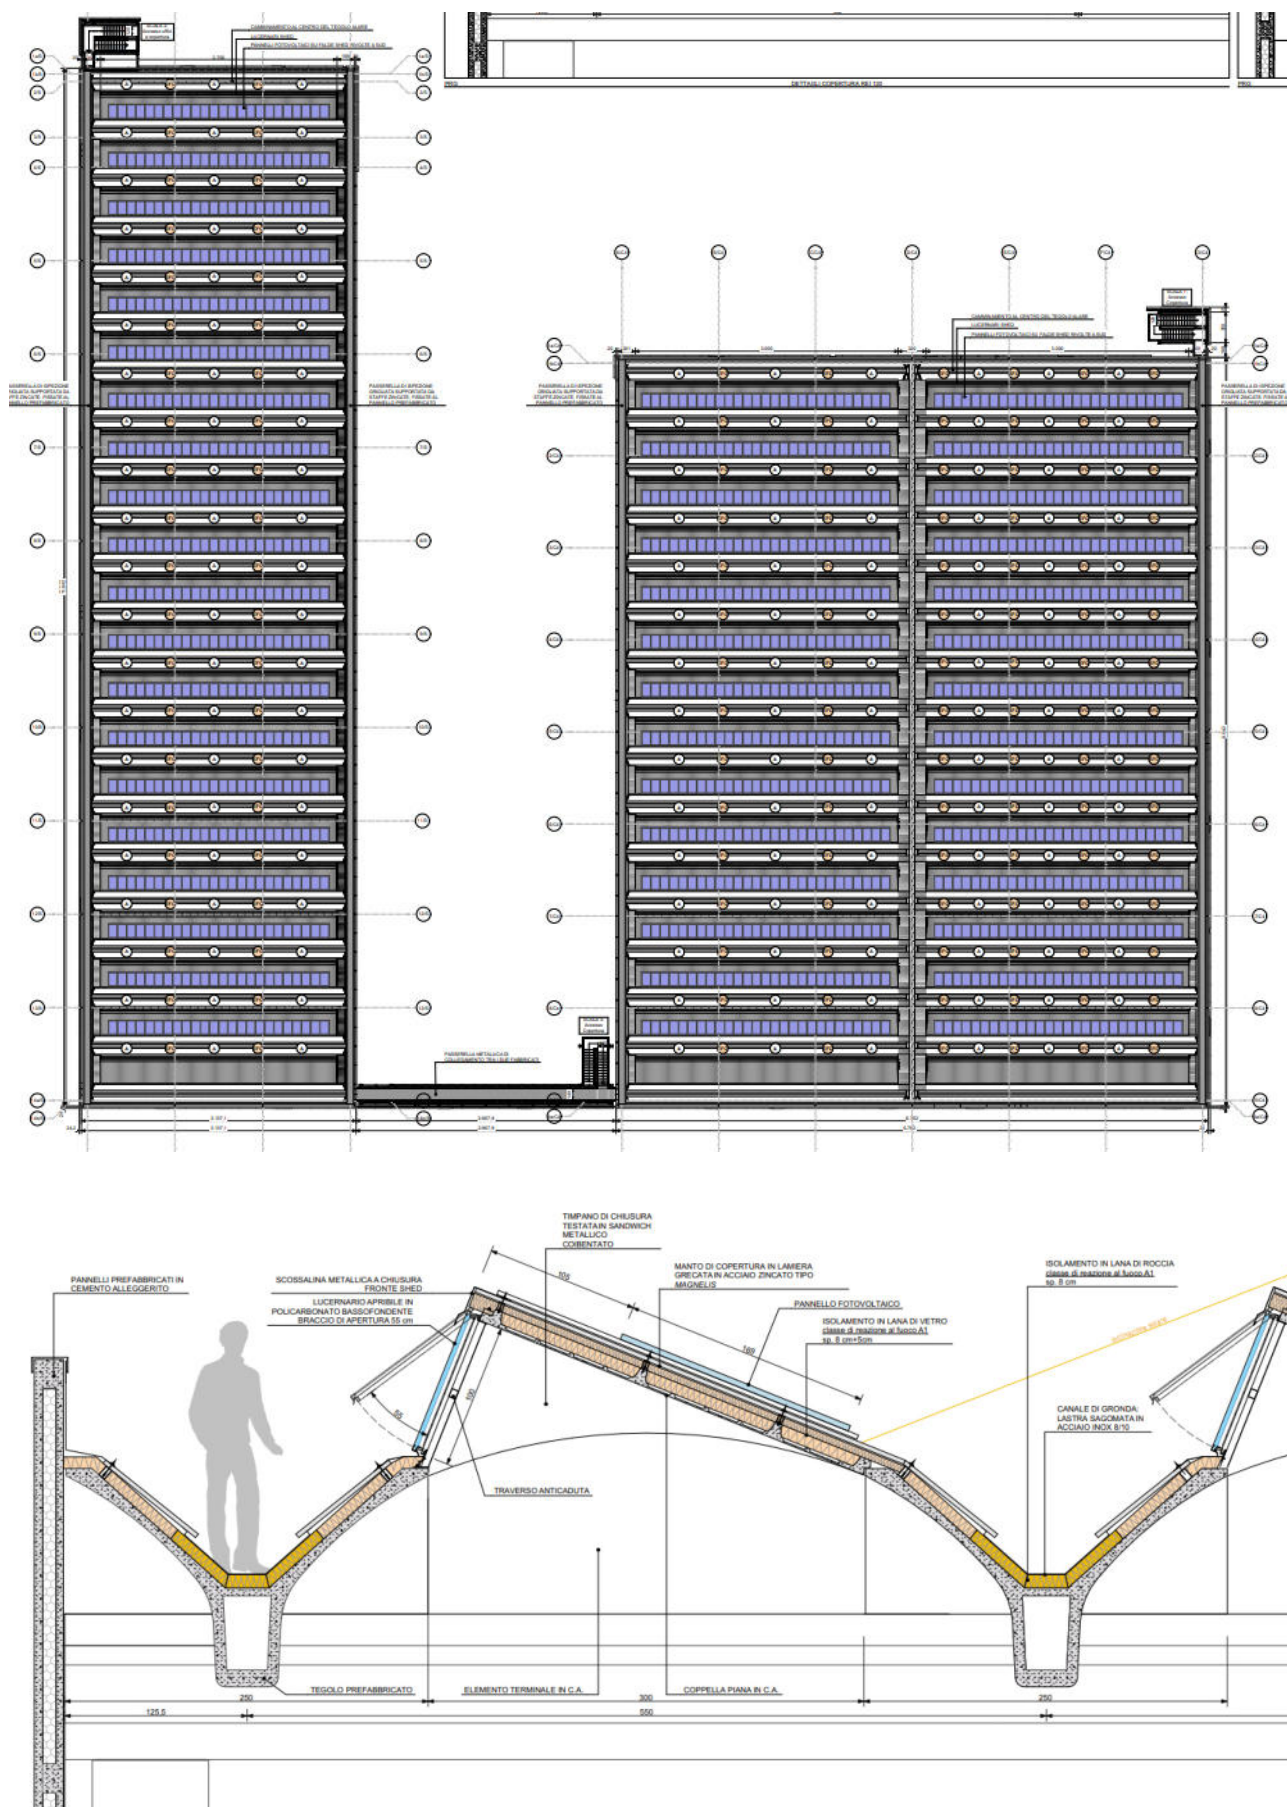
Estratto tavola A.13 "Pianta coperture e dettagli"
